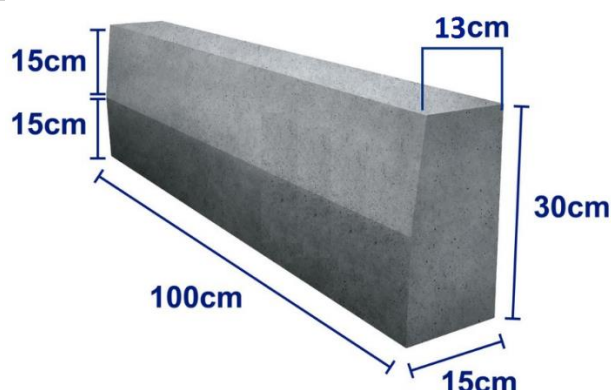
Modelo de Meio-fio de concreto pré-fabricado.
